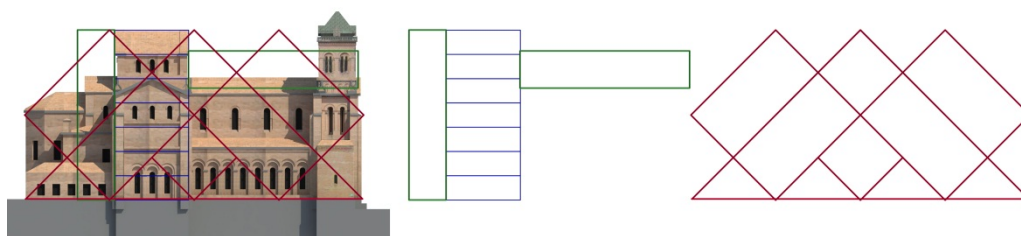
Geometría euclidiana encontrada en las fachadas laterales
